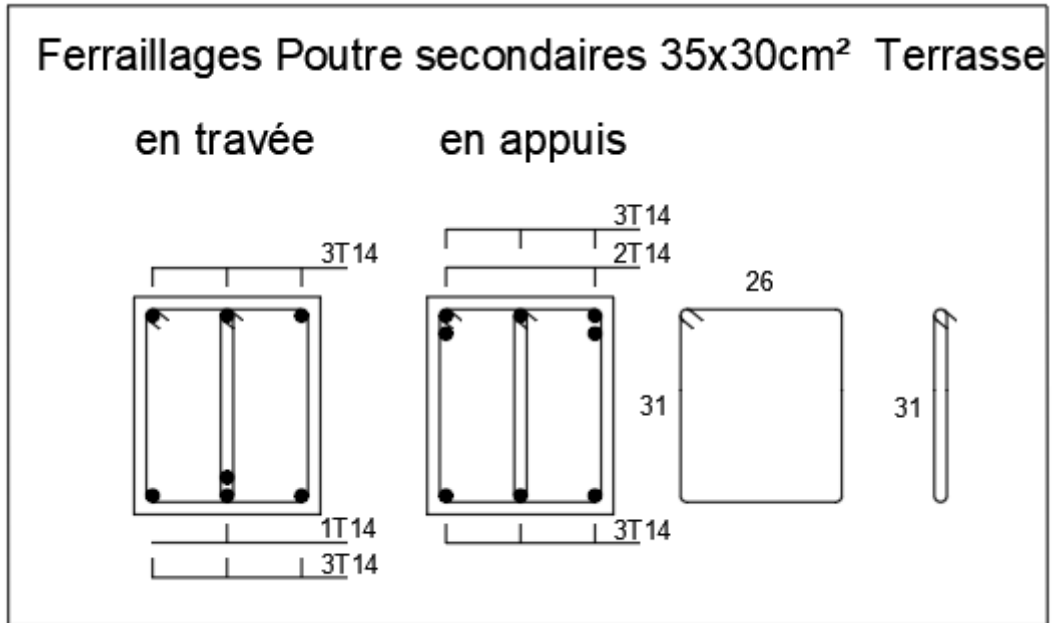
Ferrillages poutre secondaires Terrasse.
